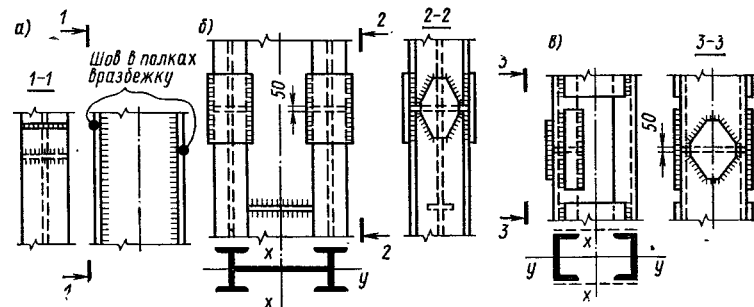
Заводские сварные стыки колонн (а—в) с элементами из открытых профилей
